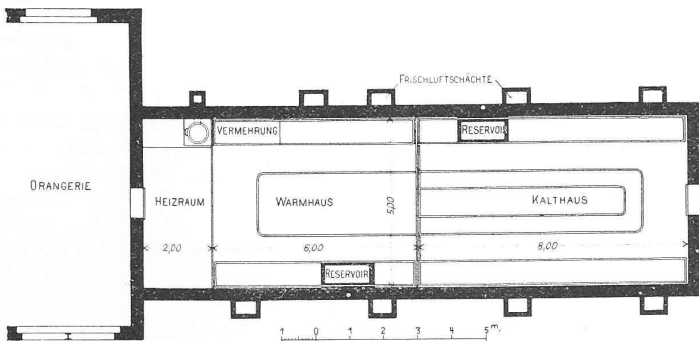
Grundriss. — Masstab 1 : 200.
